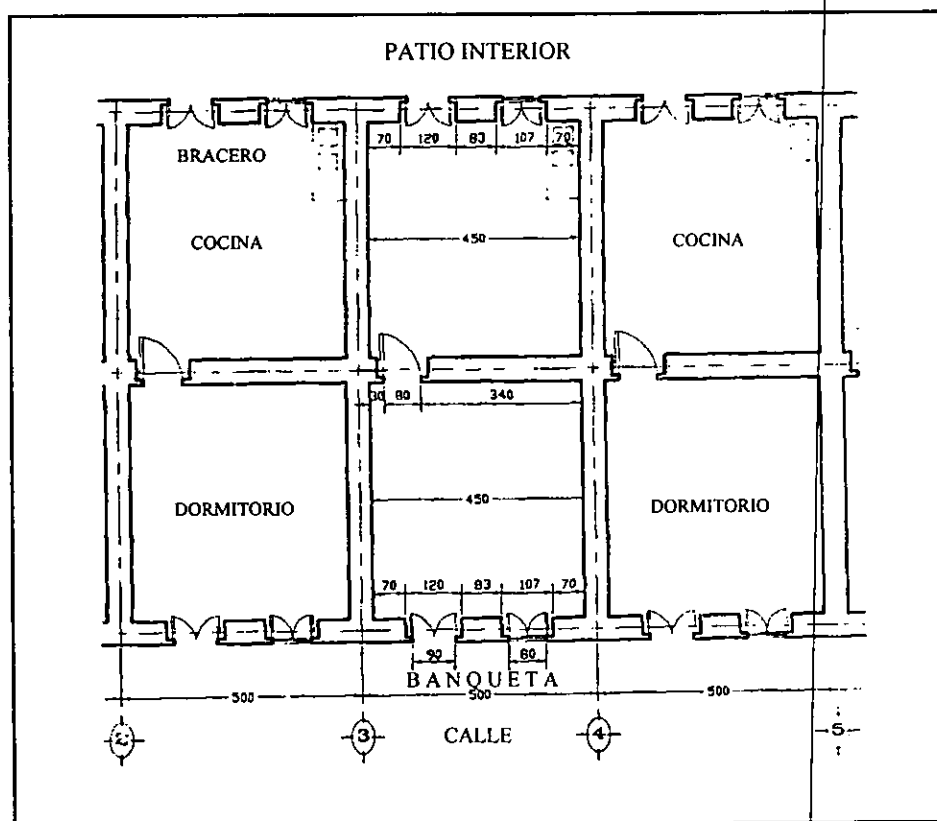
Planta arquitectónica de una vivienda con 2 cuartos cada una, con vista a la calle Hidalgo y patio interior.
